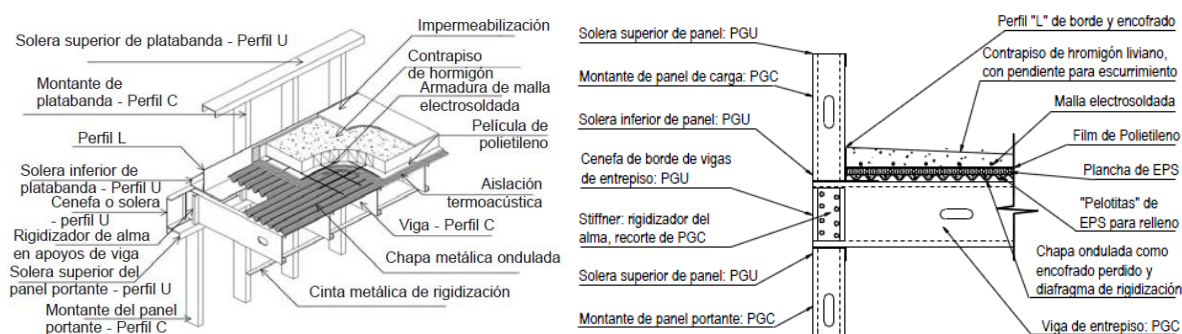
Cubierta plana. (ConsulSteel, 2002).
